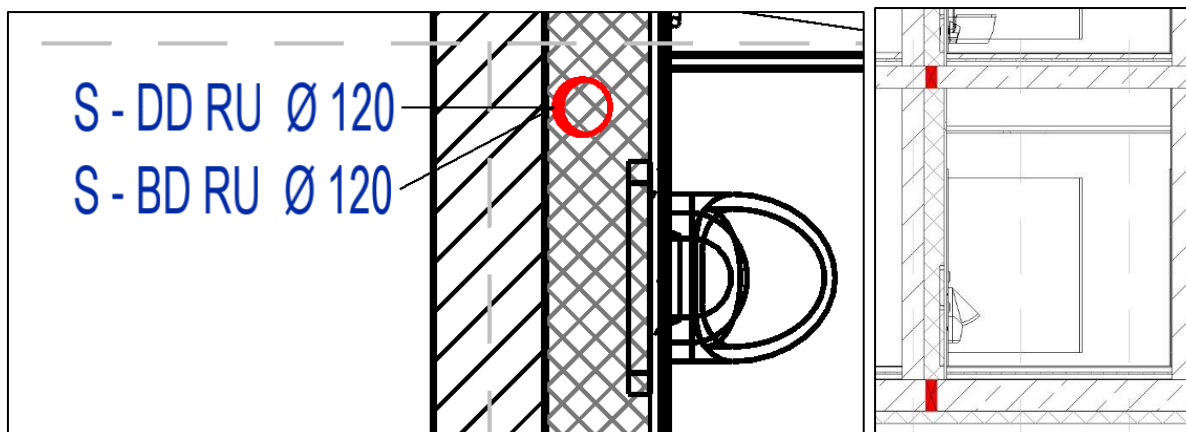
Beschriftung von Boden- und Deckendurchbrüchen in Grundriss (links) und Schnitt (rechts) beim TA-Planer
